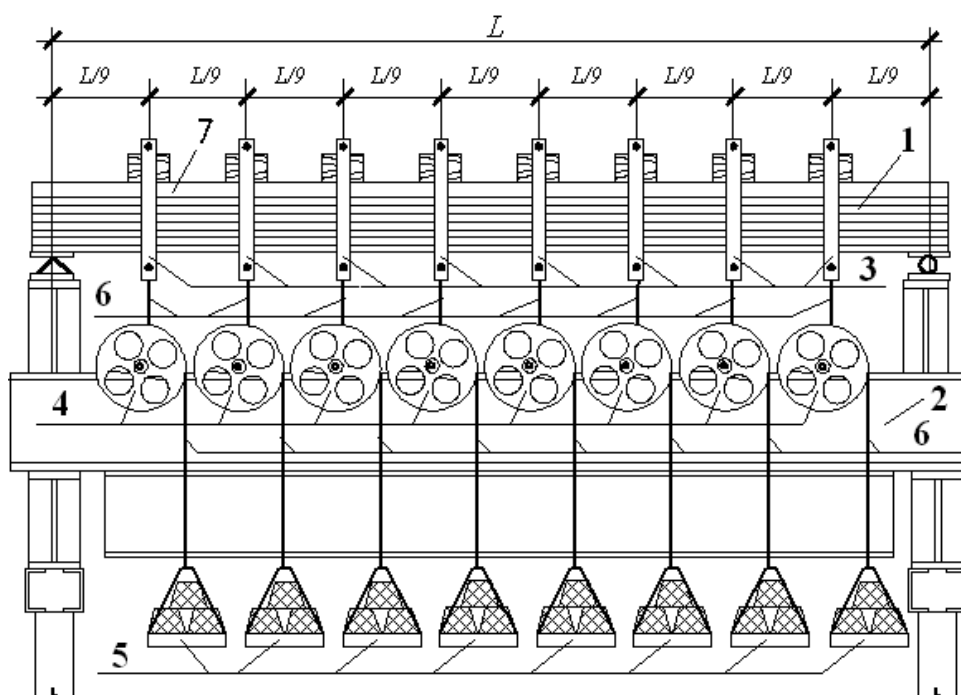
Схема экспериментальной установки для испытания балок пролетом 4,5 м:
